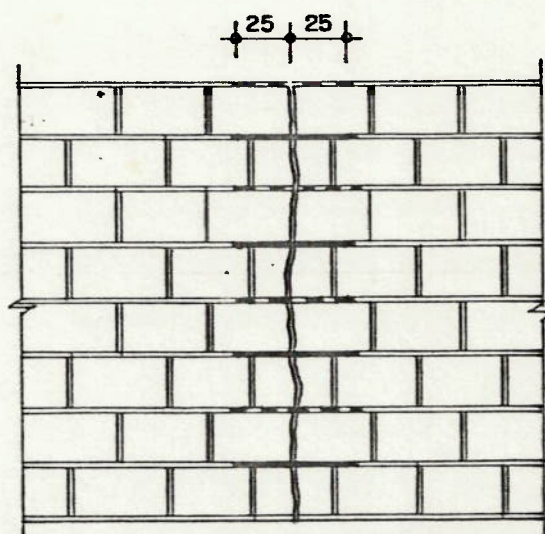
Recuperação de fissura em alvenaria aparente, com o emprego de armaduras defasadas
